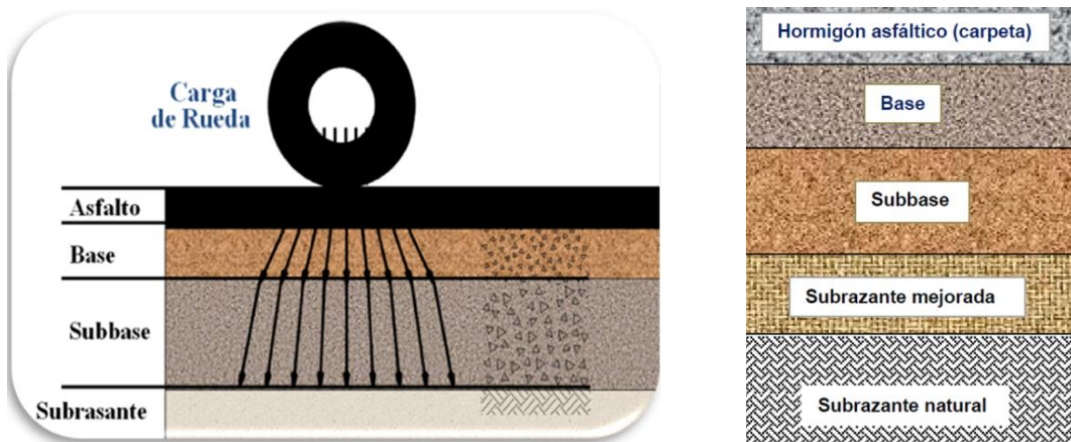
ESTRUCTURA Y COMPORTAMIENTO BAJO LA ACCION DE UNA CARGA DE UN PAVIMENTO FLEXIBLE
